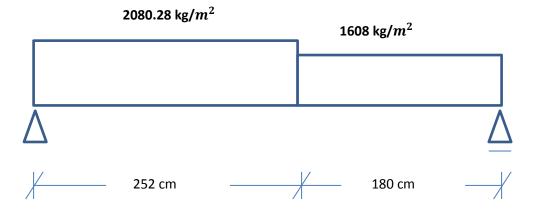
Esquema estructural Fuente: Elaboración Propia
